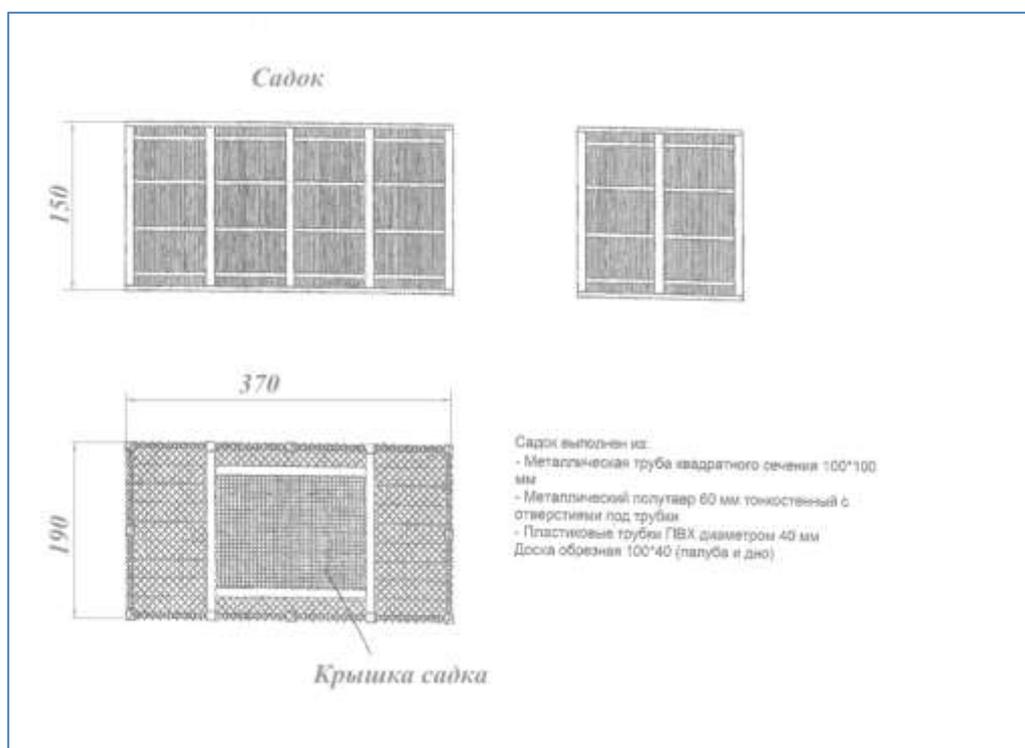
Конструктивные элементы садка рыболовной забойки
